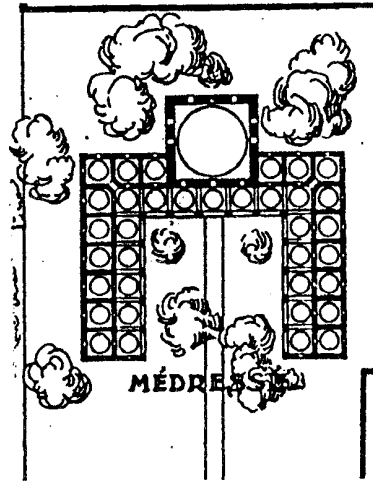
مسقط أفقي لمدرسة اسحاق باشا في اينه كول
